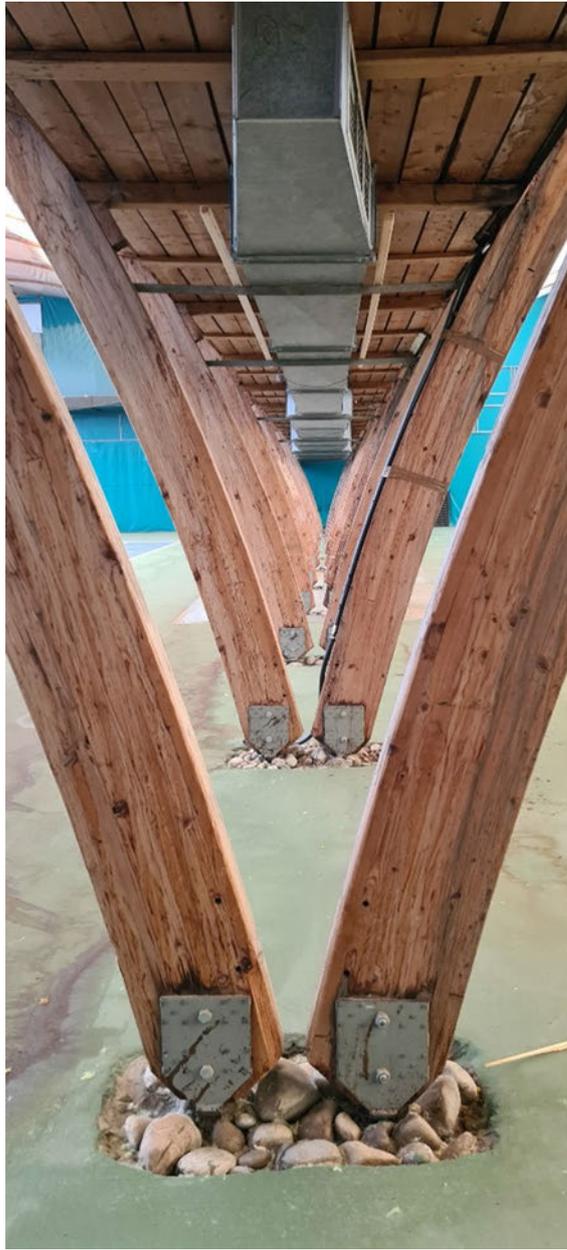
Bogen-Holzträger mit Metallfüßen auf Betonfundamenten, RLT-Kanal
